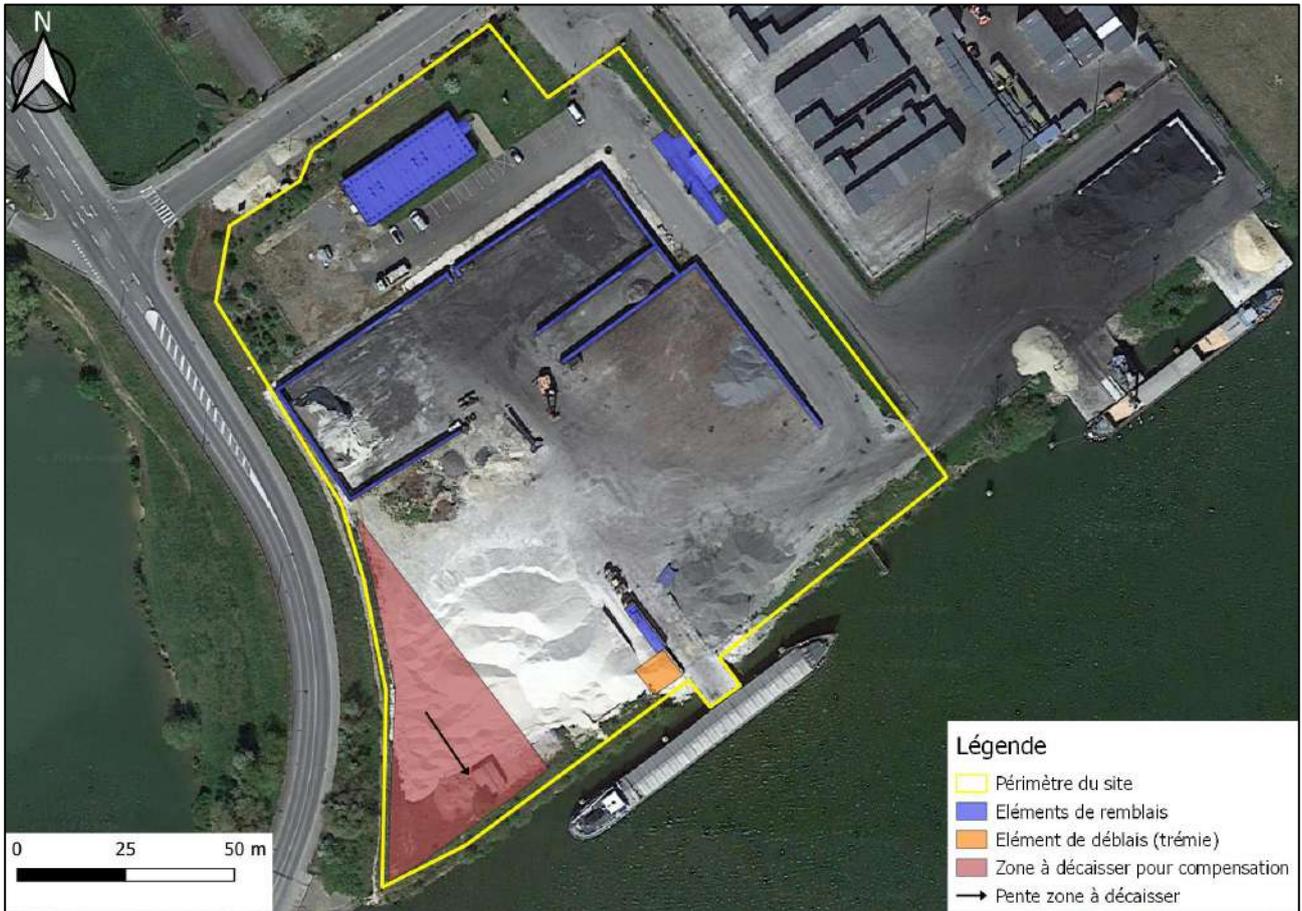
Remblais de construction/déblais identifiés sur le site depuis l'installation de STF (source : fond de plan Google Satellite)
